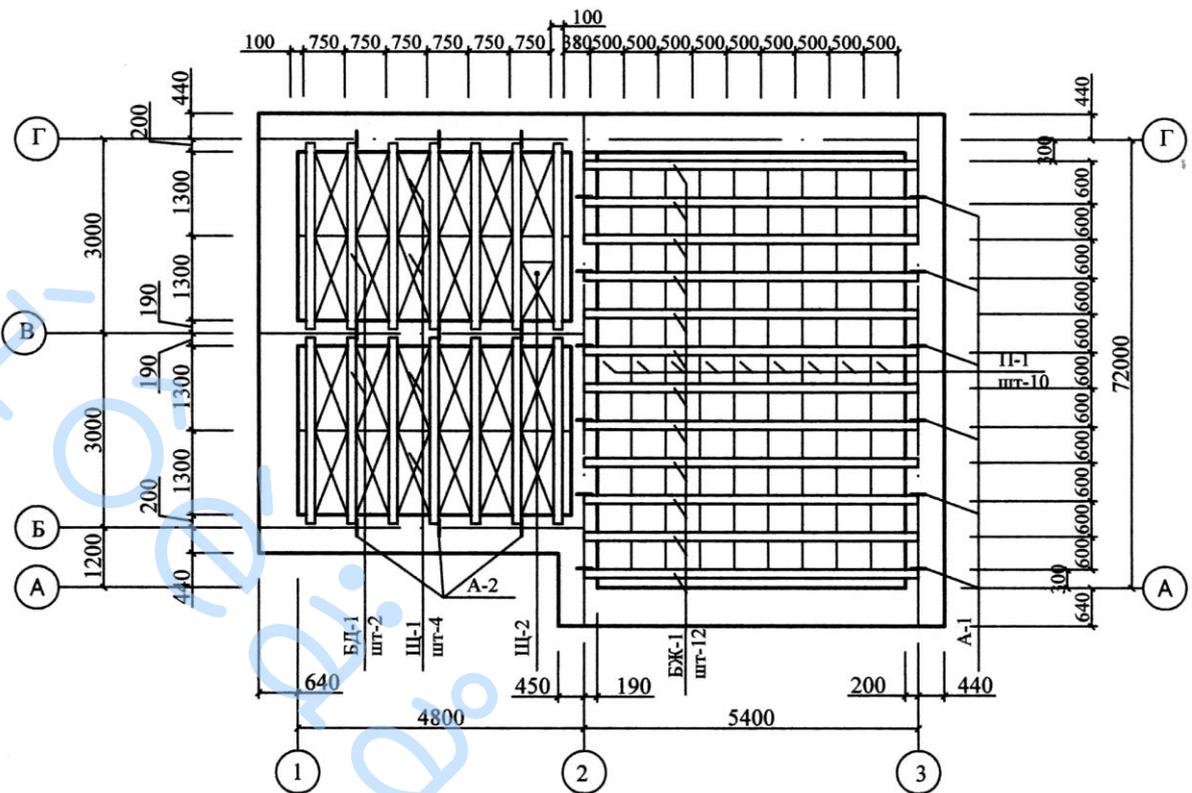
Схема раскладки деревянных и железобетонных балок междуэтажного перекрытия
